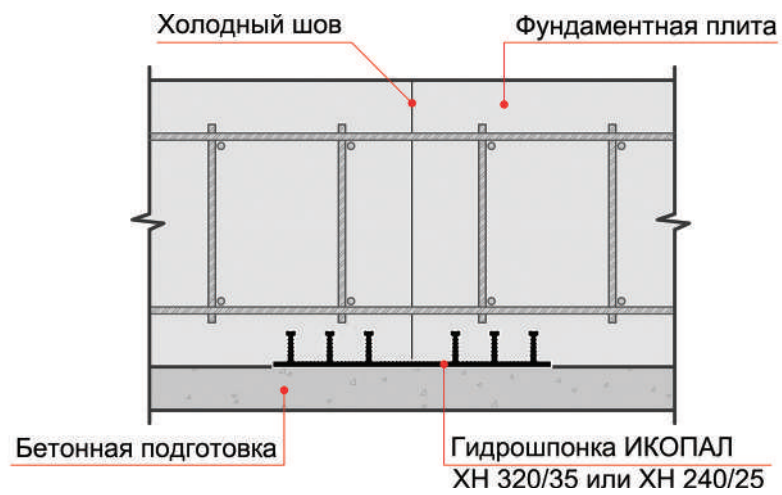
Герметизация холодного шва бетонирования в фундаментной плите
